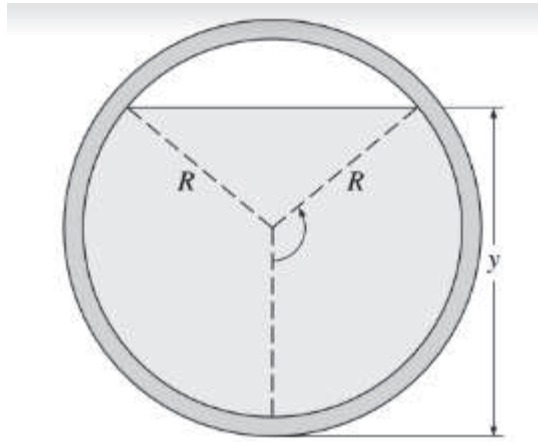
Parámetros de diseño en una cañería en canal abierto¹¹.
